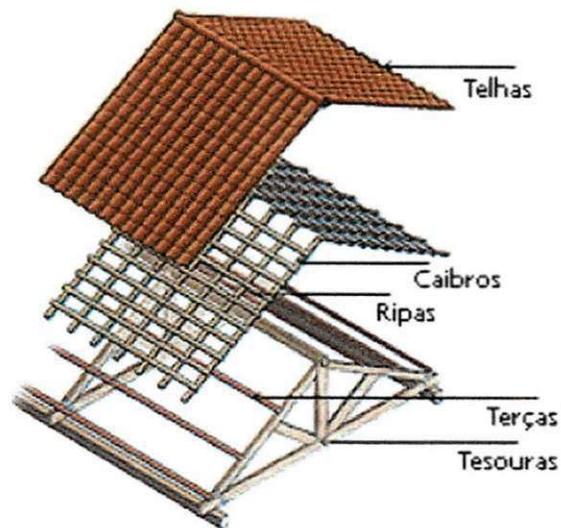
Montagem de telhado de estrutura de madeira e telhas cerâmicas
